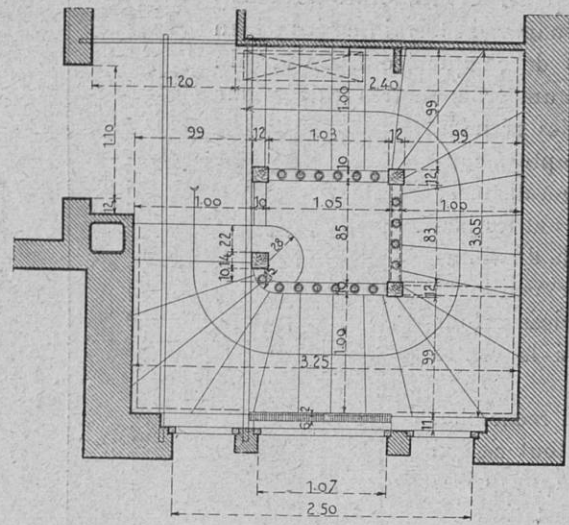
(éch. 0,015 p. m.). — Plan du rez-de-chaussée.
